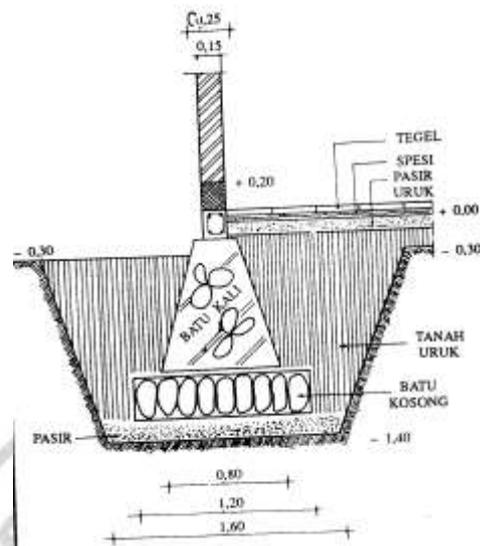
merupakan gambar potongan pondasi suatu bangunan. Pada gambar potongan tersebut terlihat penampang pondasi, slof, dan dinding bangunan. Kemudian dapat juga dilihat ukuran dari pondasi, baik ukuran bagian atas, bagian bawah dan tinggi/dalam pondasi. Lebih lanjut terlihat luasan tanah urug/timbunan, dalam galian tanah untuk pondasi serta tinggi lantai bila dibandingkan dengan muka tanah.
